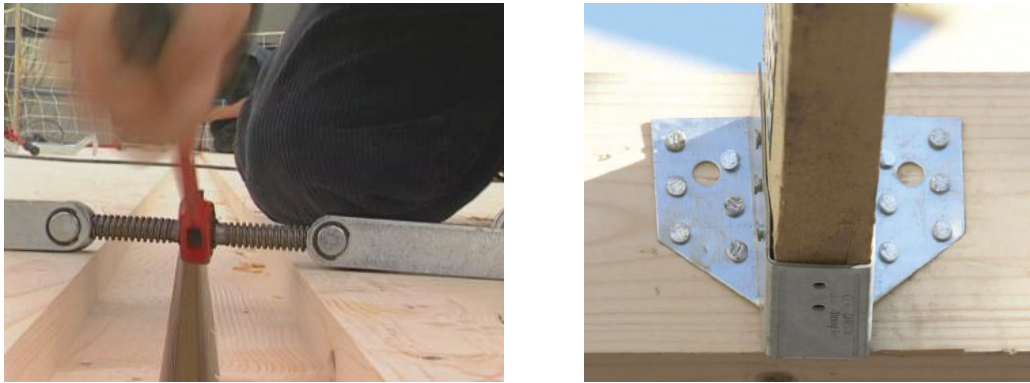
Ligação entre painéis [22] e armadura portante [23]
